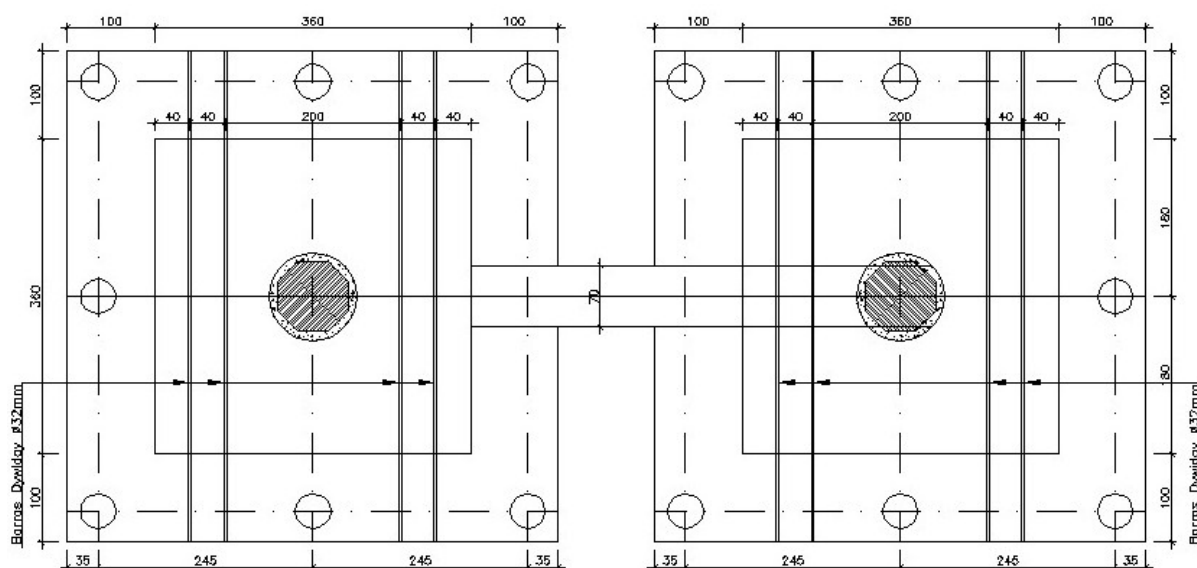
Configuração horizontal do reforço do estaqueamento.
